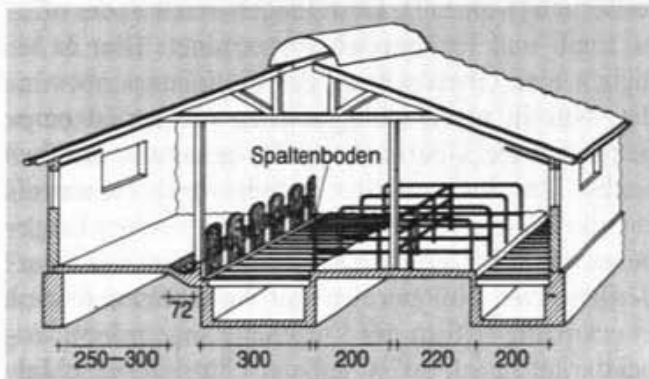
Grundform des geschlossenen Liegeboxenlaufstalles (Maße in cm).
